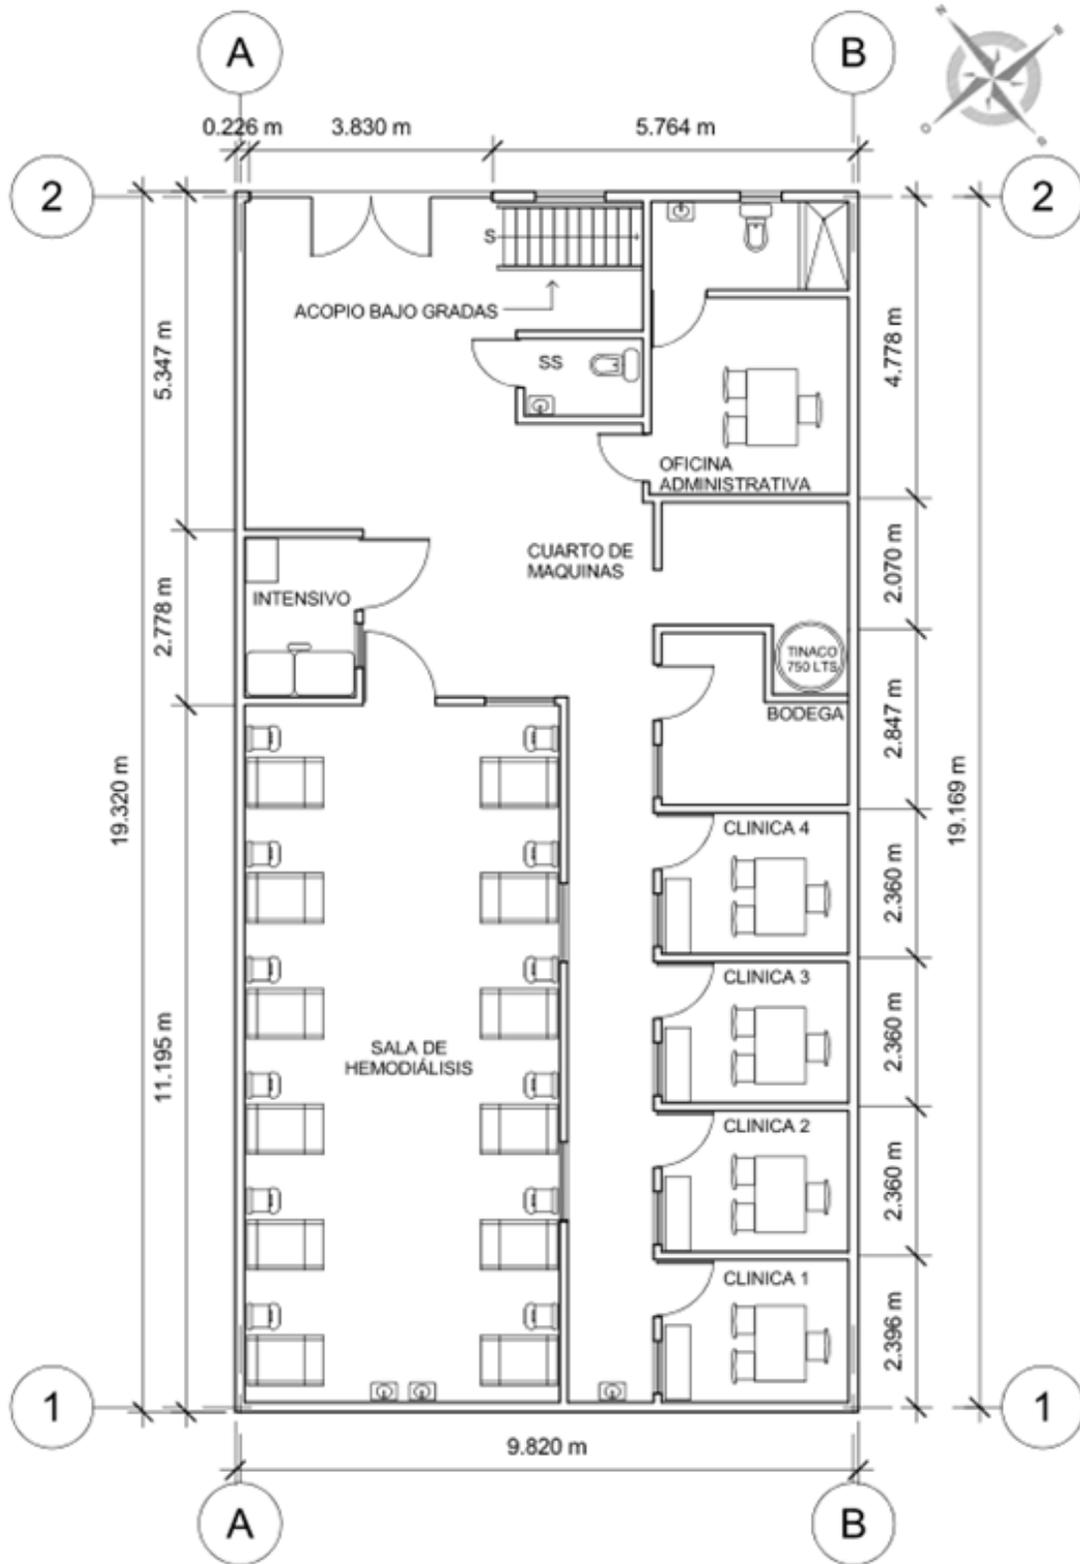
Planta amueblada UNAERC, Fuente: elaboración propia
